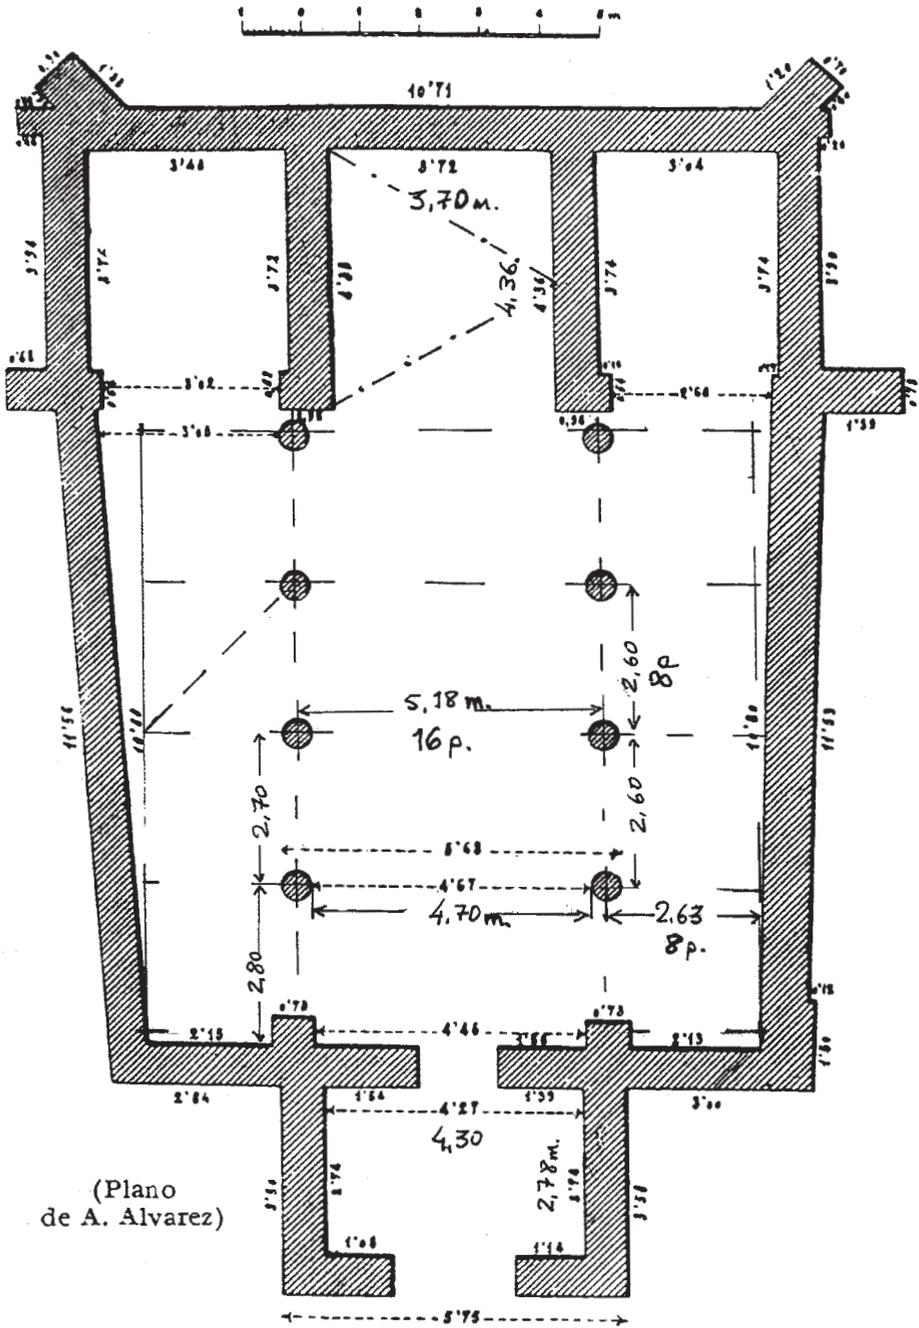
San Juan de Baños. Medidas en metros y pies sobre la planta de A. Álvarez.
